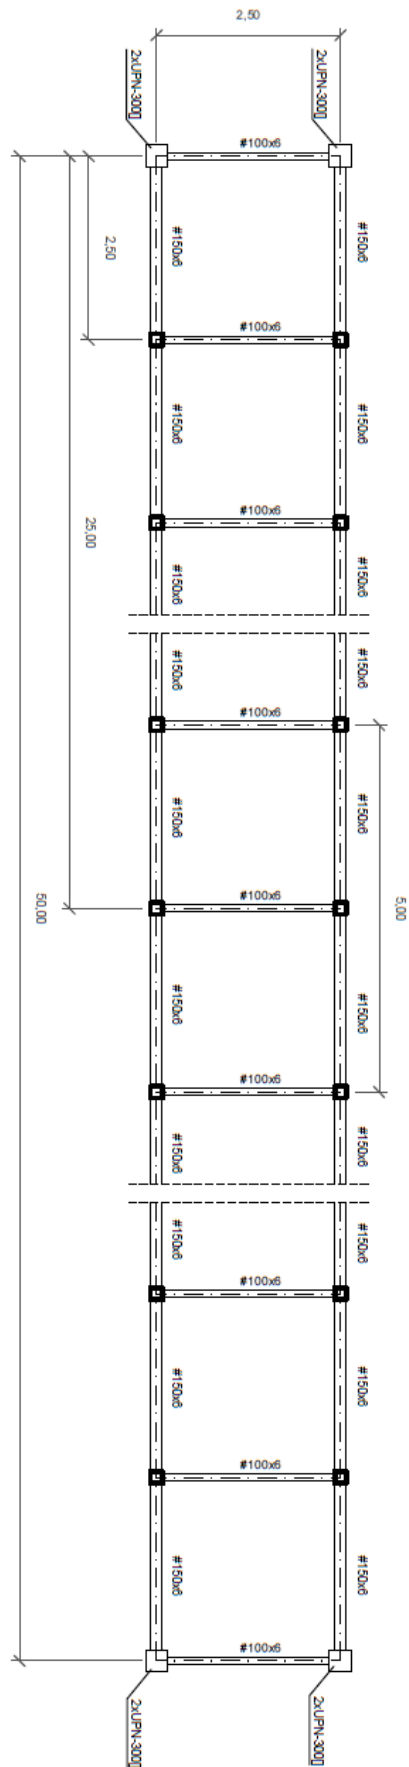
Vista planta de la estructura del rack de tuberías.
